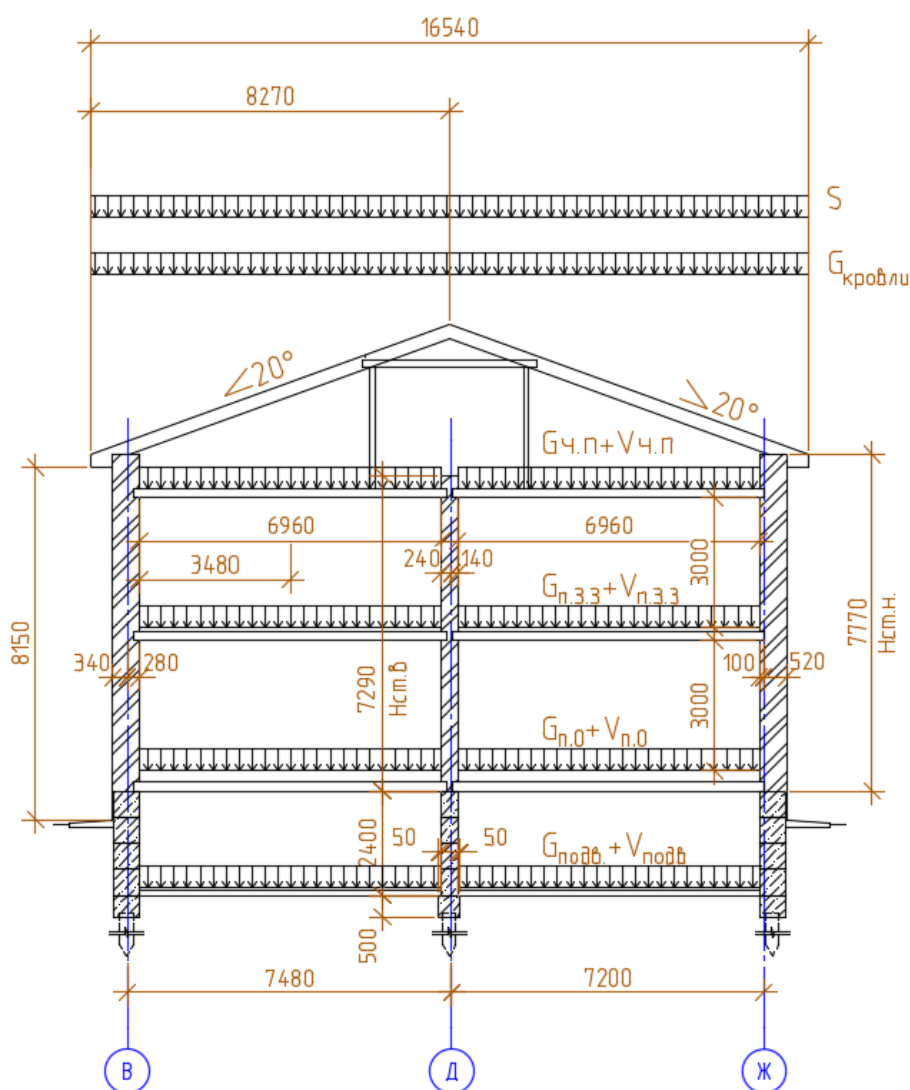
К расчету постоянных и временных нагрузок на фундамент
